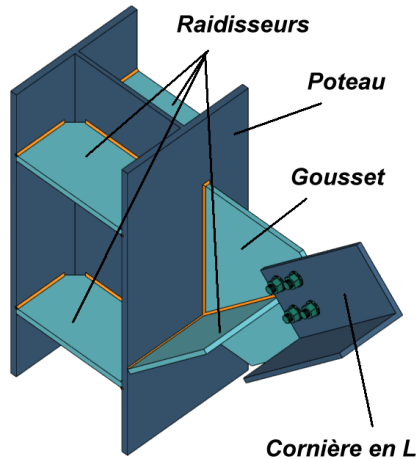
Articulation poteau-barre de contreventement en cornières par gousset sur semelle et raidisseurs
